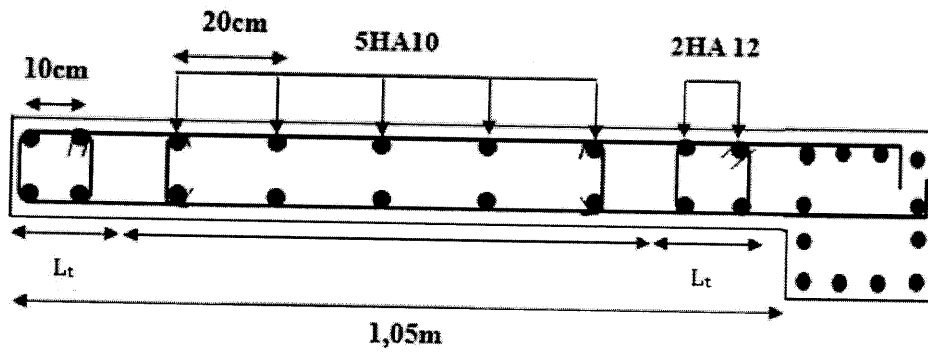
Schéma de ferrailage de voile longitudinale V3.
